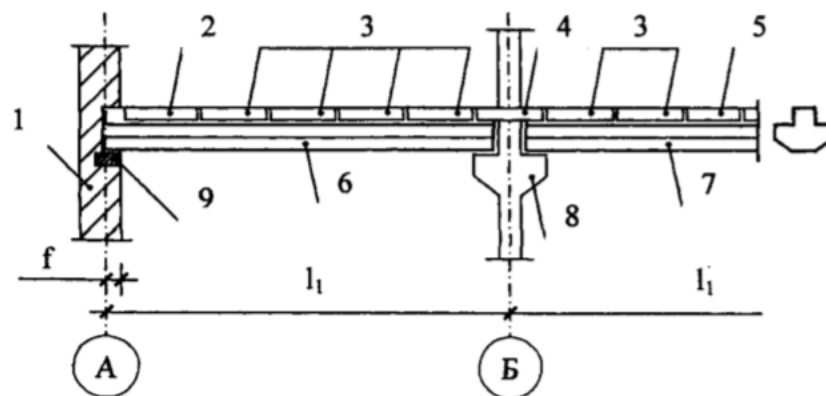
Поперечный разрез - несущие конструкции (стена, колонна, перекрытие): 9 - распределительный железобетонный брус (опорная подушка)
